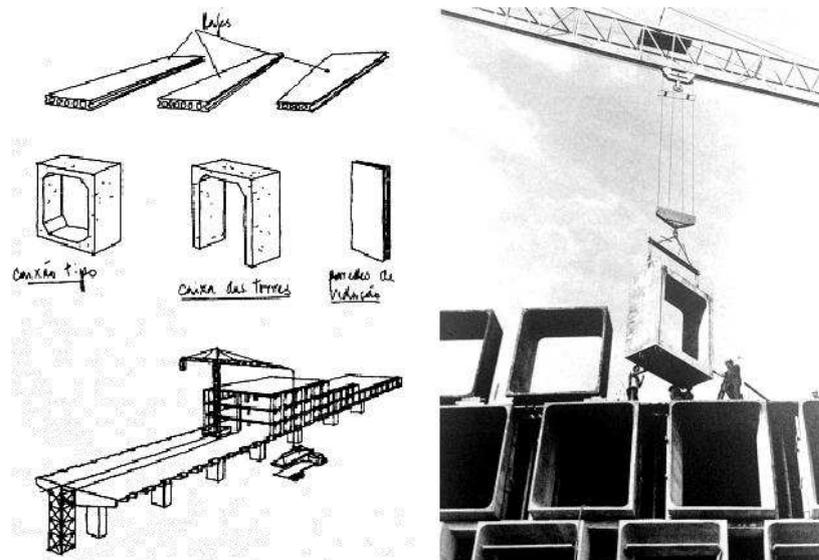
Hospital de Taguatinga - Croqui e montagem de peças das caixas pré-fabricadas.
